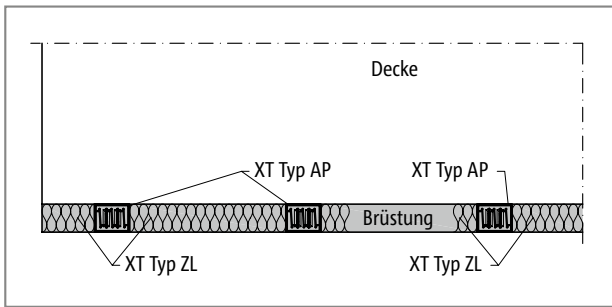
Schöck Isokorb® XT Typ AP vertikale Anordnung: Grundriss Brüstung aufgesetzt
